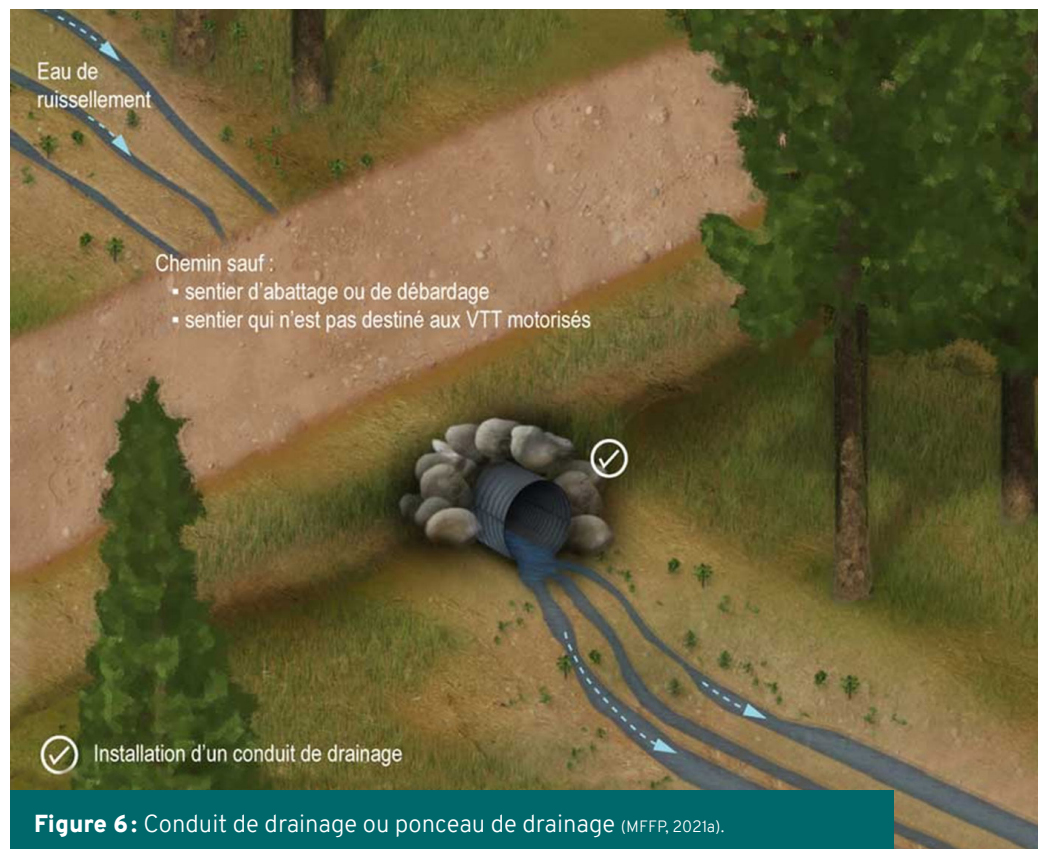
Conduit de drainage ou ponceau de drainage (MFFP, 2021a).
